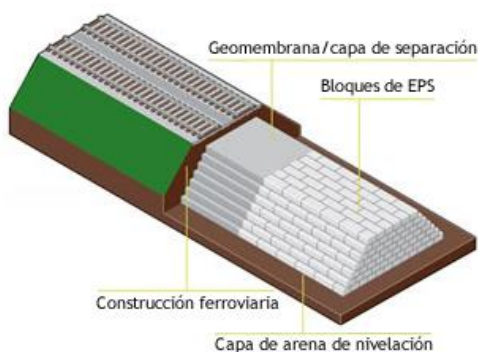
EPS en estructuras ferrocarril (anape)
